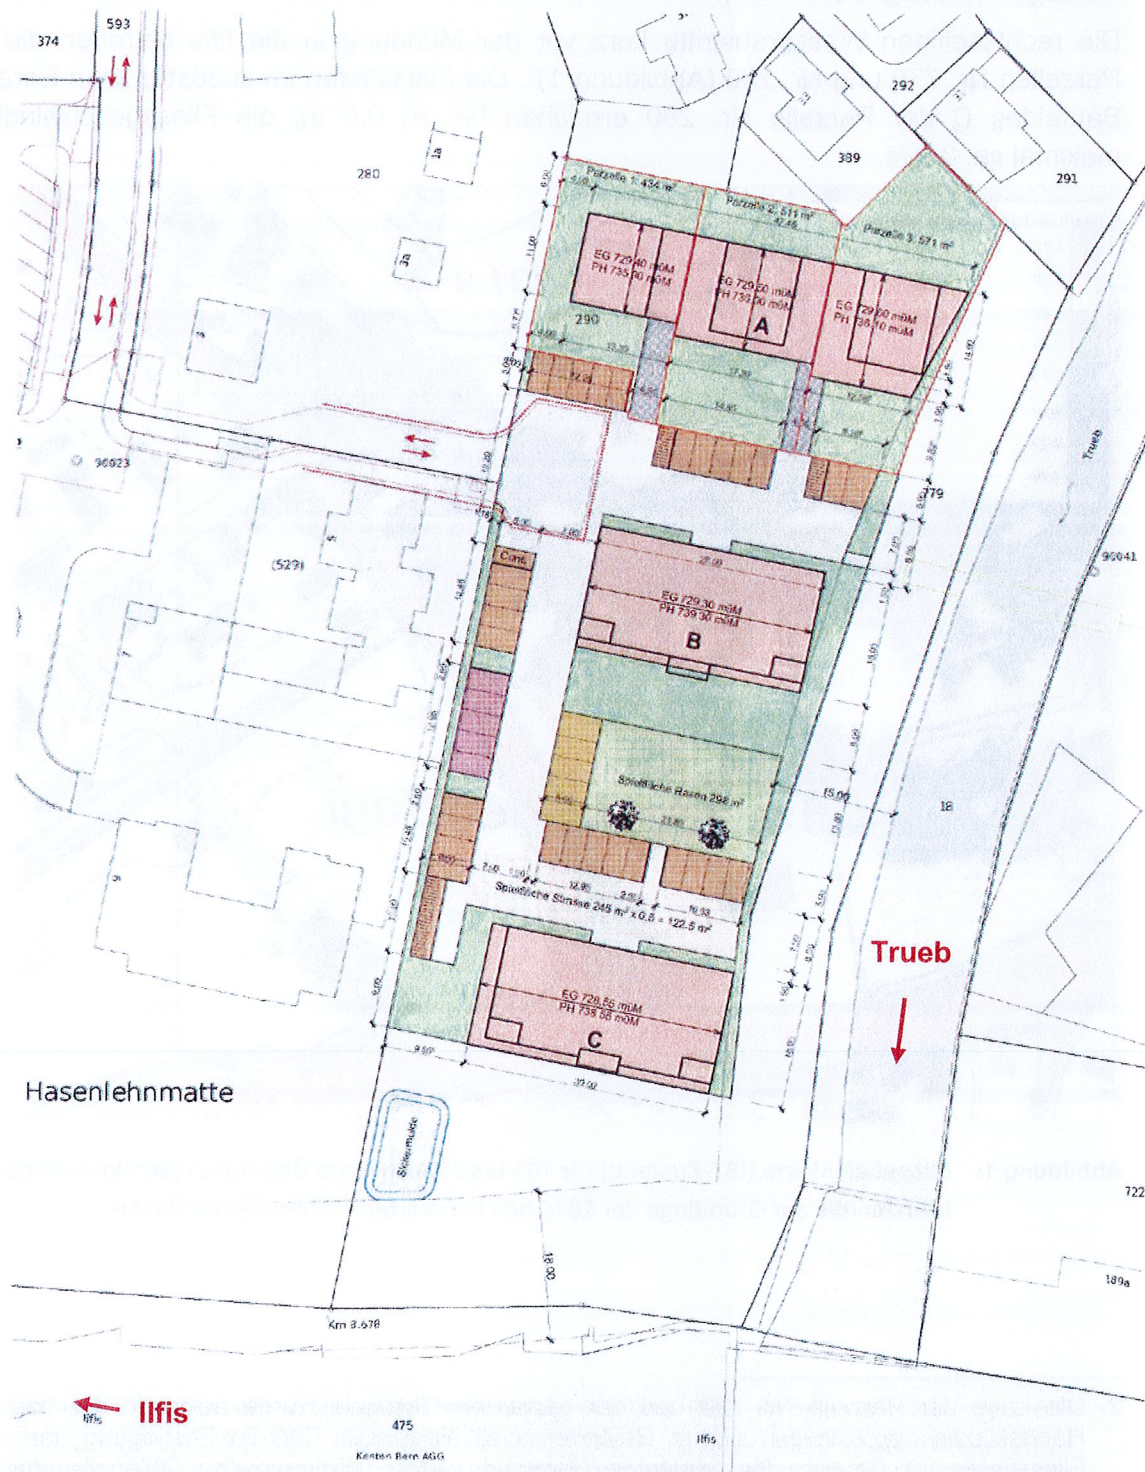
Überbauungsplan Himmelhausmatte, Trubschachen [4].
